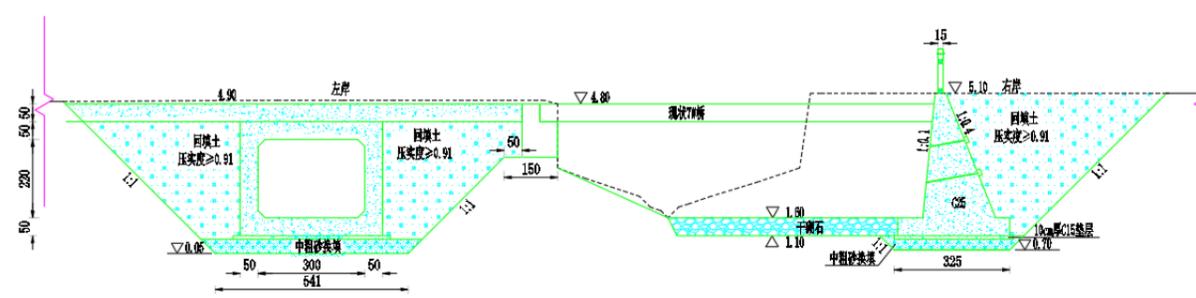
7#桥剖面图(下游侧) 典型断面图
